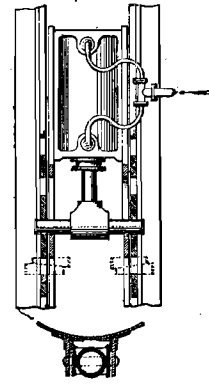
Presse hydraulique pour opérer la descente de la plate-forme.
